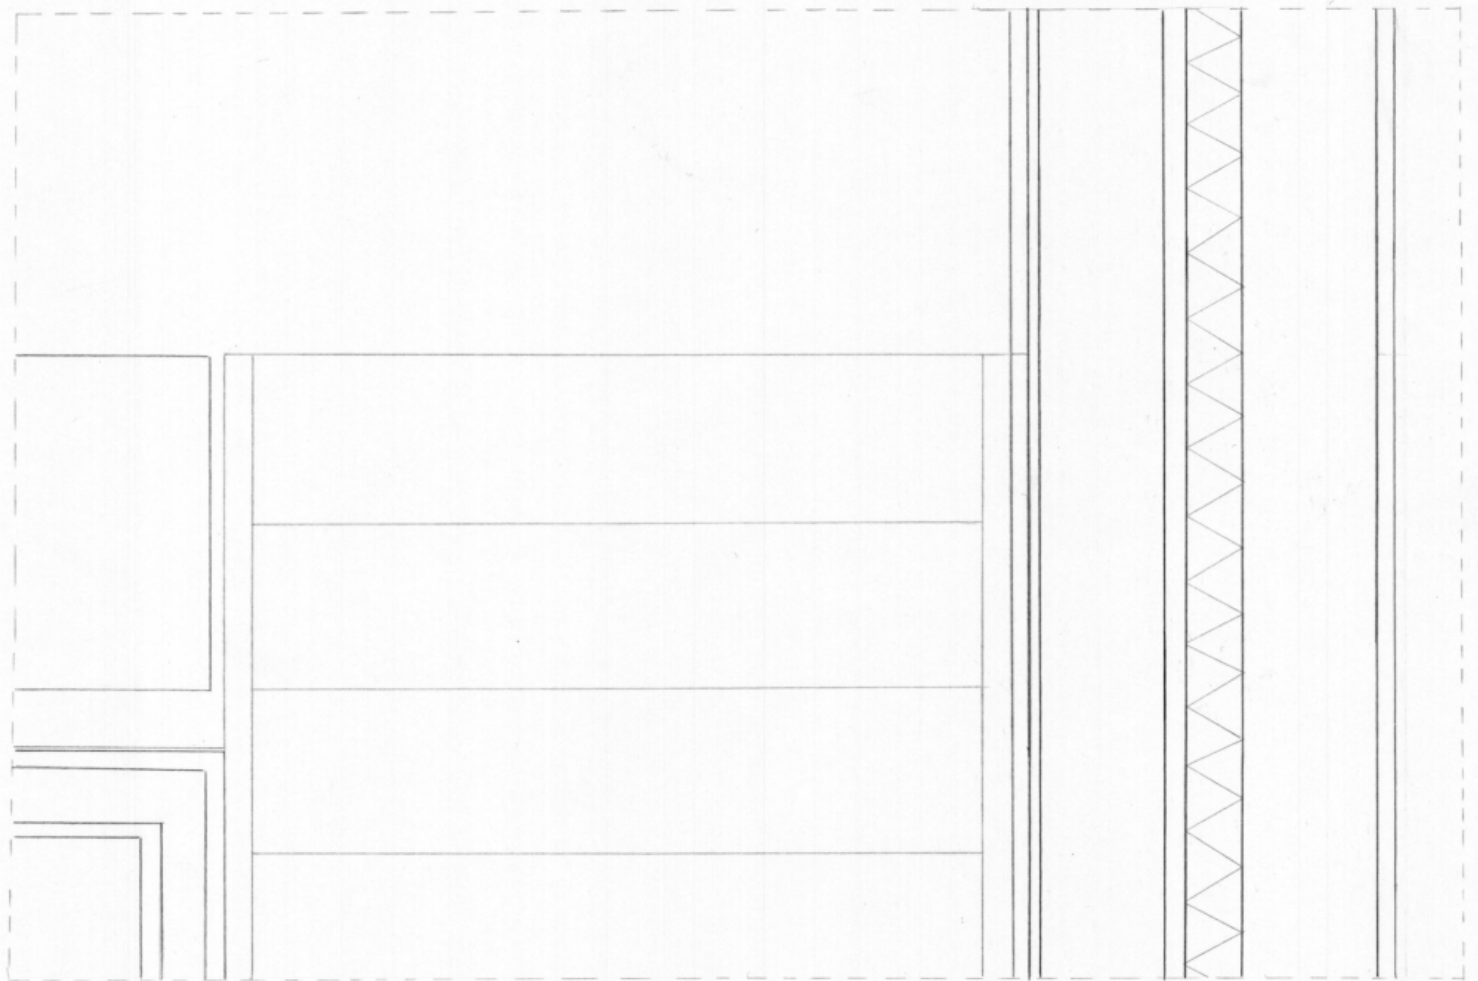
D4 - Detalhe em planta da escada interior, escala 1:10.
